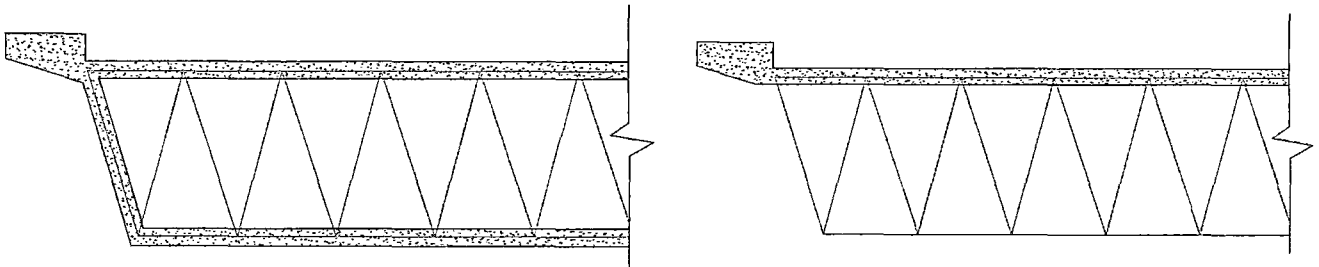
Detalles Típicos de un Puente que emplea Tridilosa
